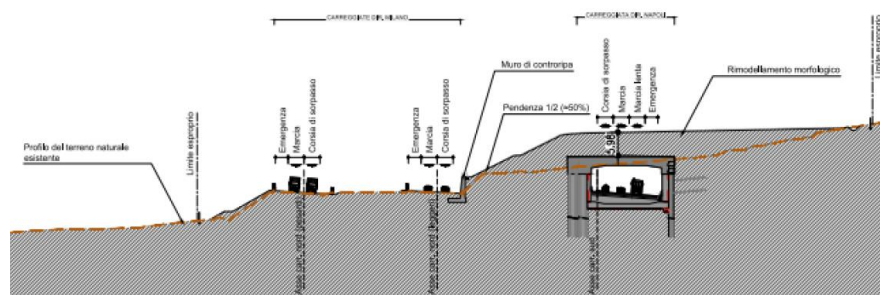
Sezione di progetto con galleria artificiale (pk 10+200)
